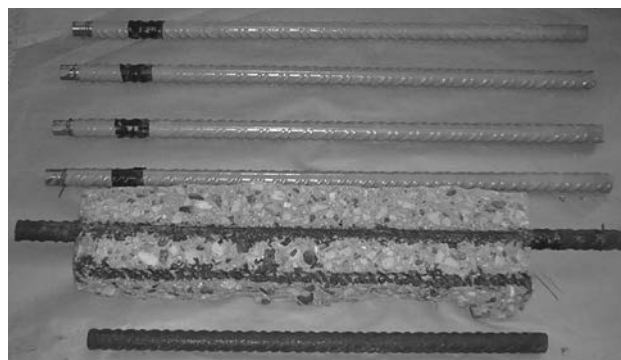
Estado de las seis barras tras el ensayo de corrosión acelerada en la losa con barras de diámetro 25 mm
